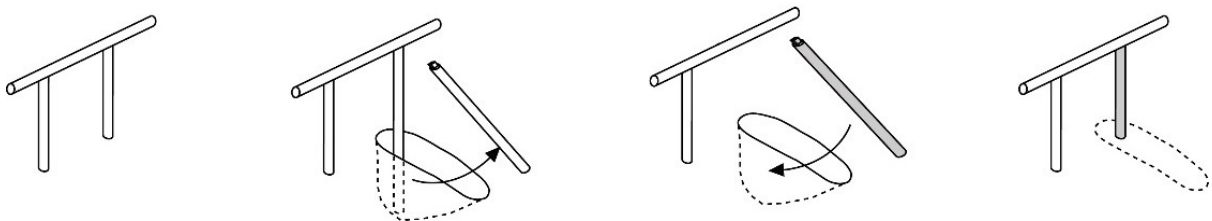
Creusement en sous-œuvre d'une fosse latérale pour l'extraction et le remplacement d'un poteau
